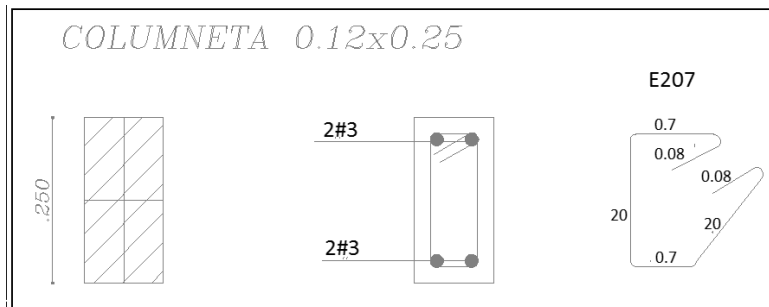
Diseño sección transversal de columna-bajado de AutoCAD
